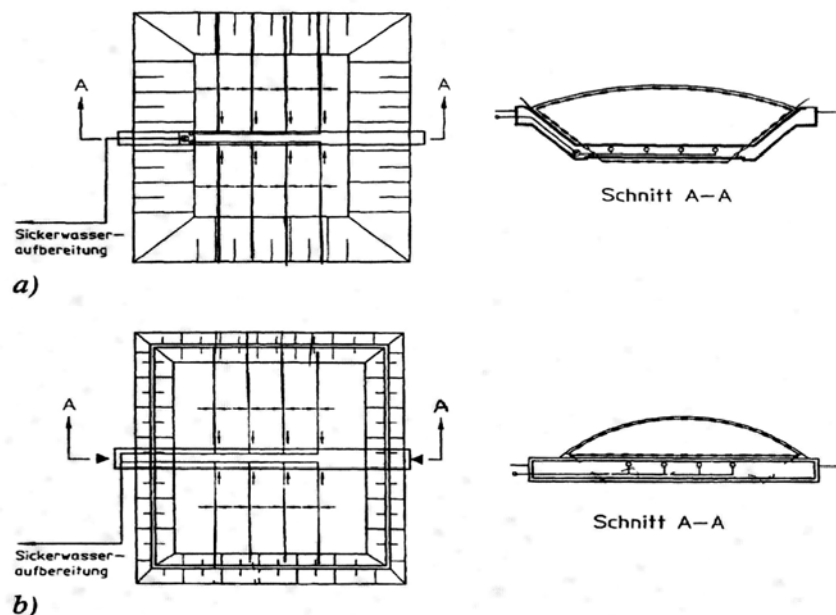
Schrägschacht mit Stollenbauwerk (Grunddeponie)
